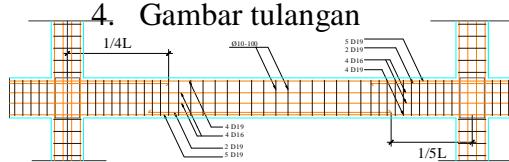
Skema penulangan balok lantai 2 (balok 35 x 75 )
